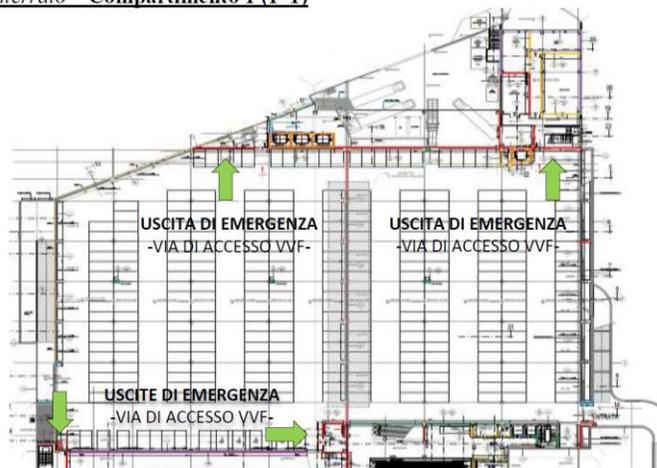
a - Planimetria *compartimento 1*(P-1) e individuazione vie d'esodo e di accesso VVF.
